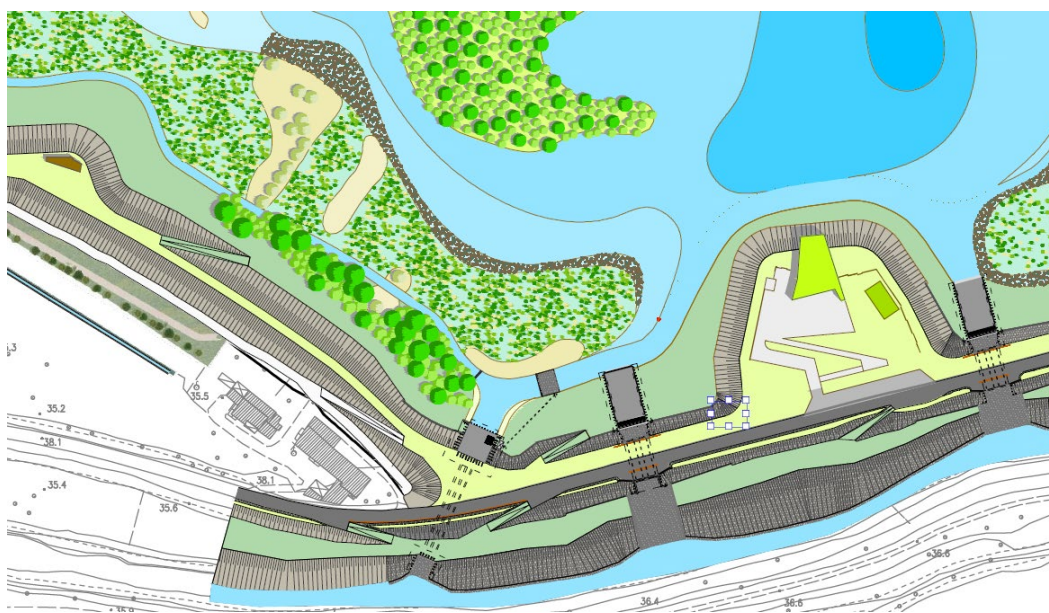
Planimetria generale dell'accessibilità all'osservatorio ovest
